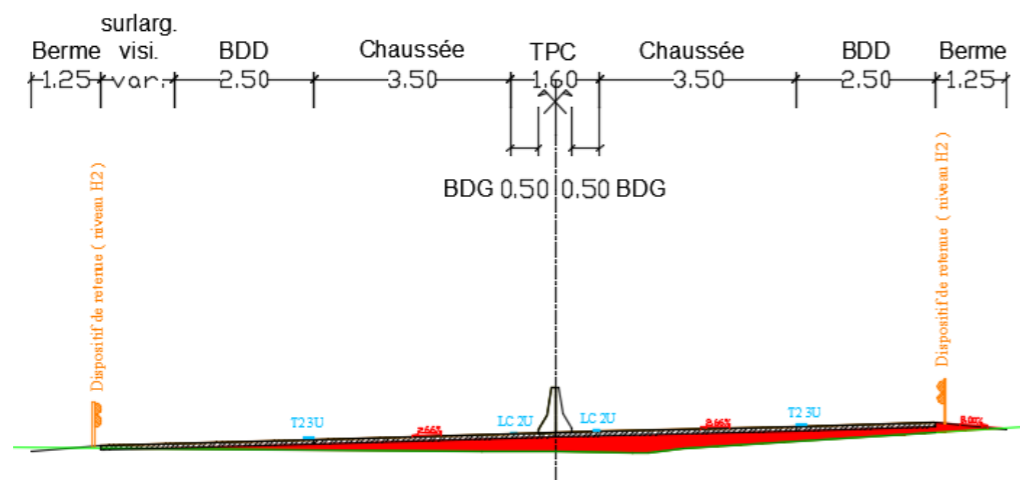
Profil bidirezionale a 2 x 1 corsia – Profil trasversale
